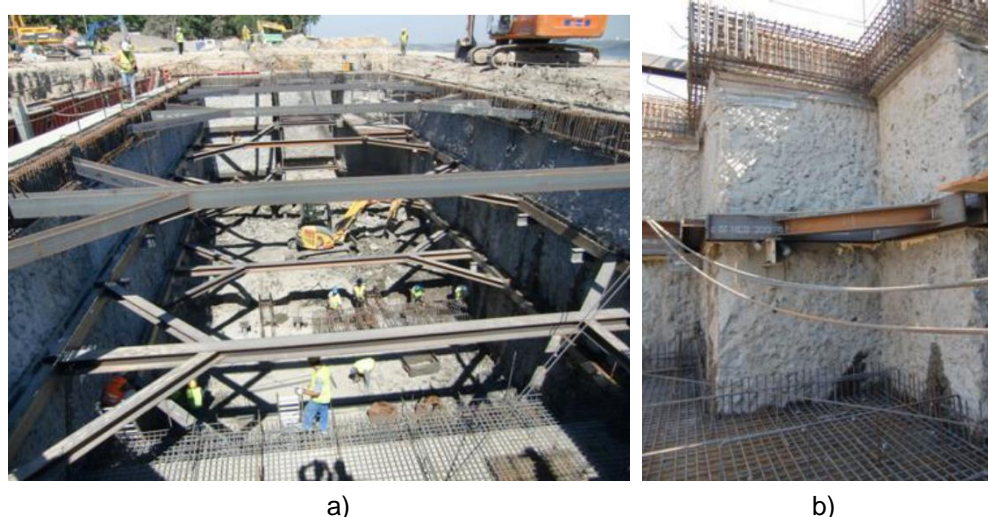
a) Vista da obra na fase final da escavação; b) Pormenores de compatibilização com a estrutura interior e painéis CSM (Matos Fernandes, *et al.*, 2010).
